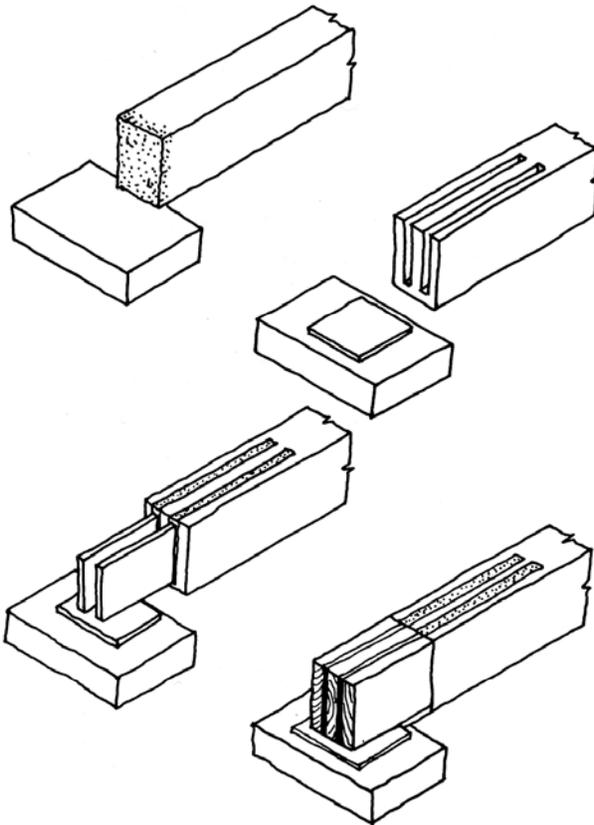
Consolidación de la cabeza de una viga mediante placas encoladas a la madera.
